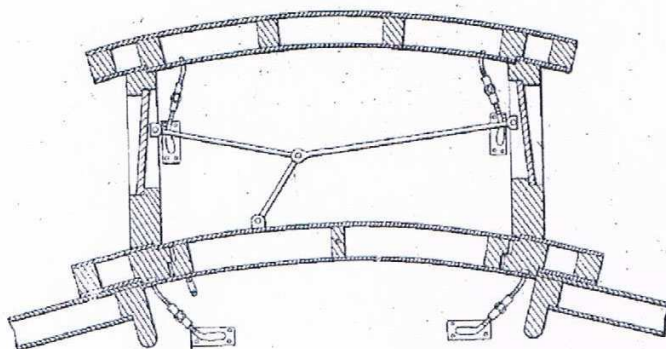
Coupe verticale de l'assemblage de la toiture et lanterneau
